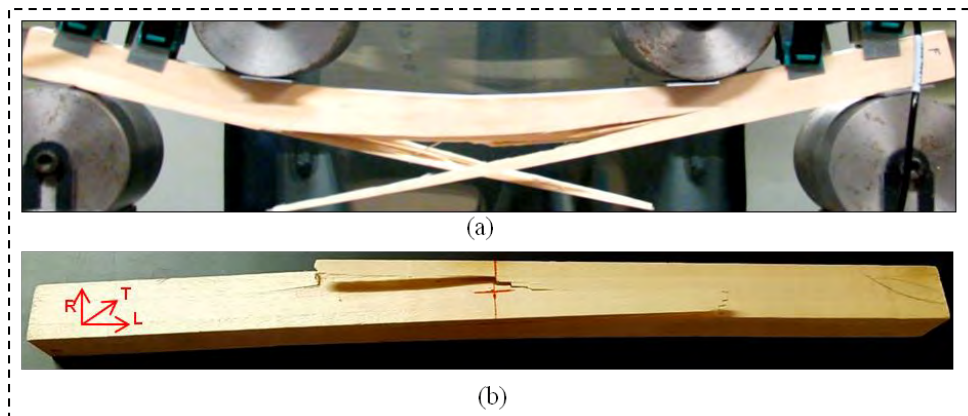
Faciès de rupture de l'éprouvette FP2 (a) une face LT (b) partie tendue à la face LR
